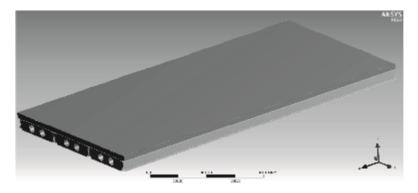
Компьютерная модель сталежелезобетонной плиты с ребрами и легкобетонными вкладышами (показана половина плиты)
